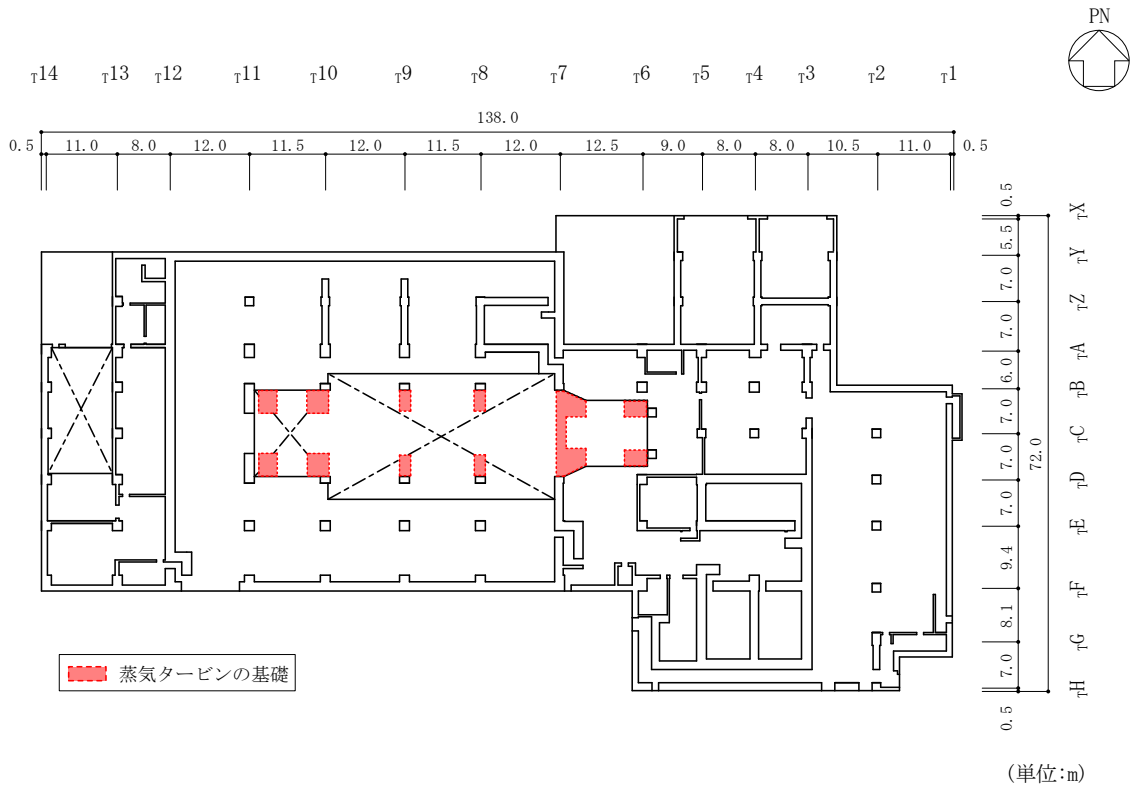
(1) タービン建物の概略平面図 (EL 12.5m)
